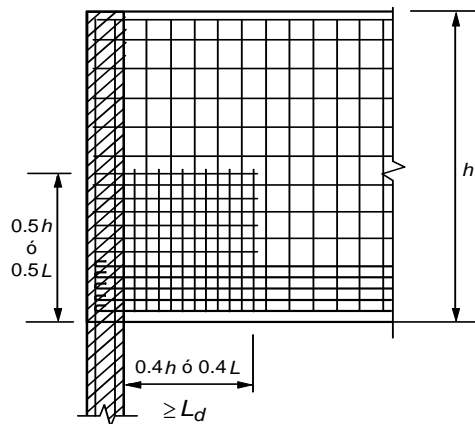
Refuerzo en una zona de apoyo indirecto
